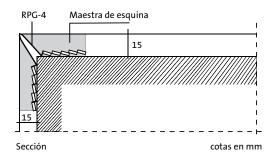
Guardavivos colocado (NTE-RPG 74)
